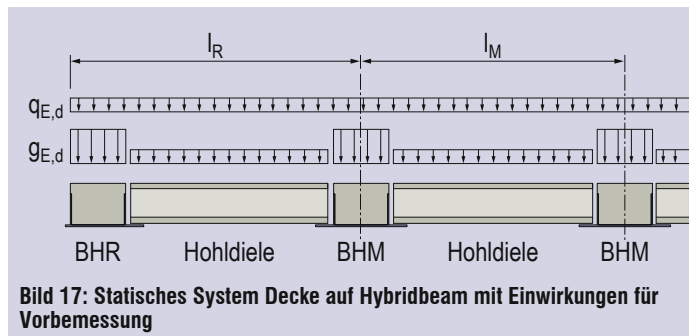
Statisches System Decke auf Hybridbeam mit Einwirkungen für Vorbemessung
